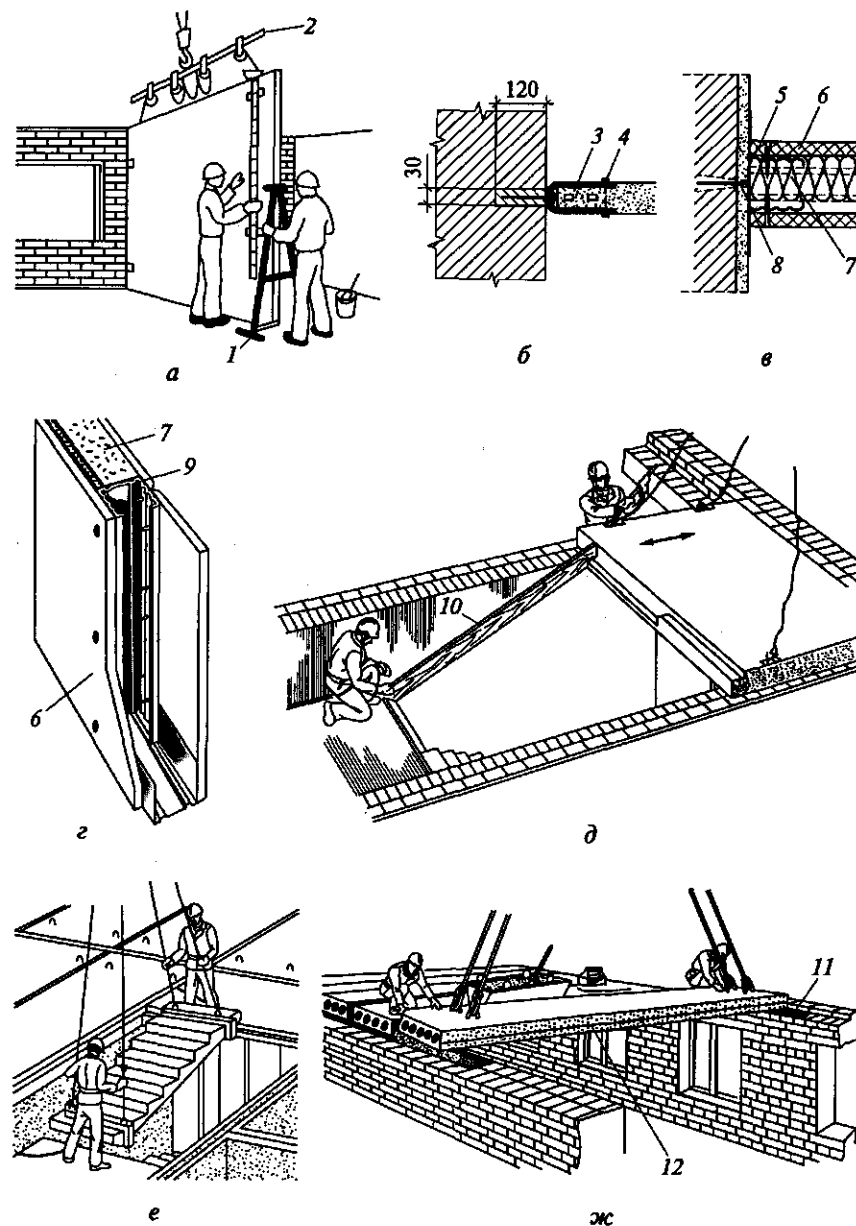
Схемы установки сборных железобетонных элементов:
